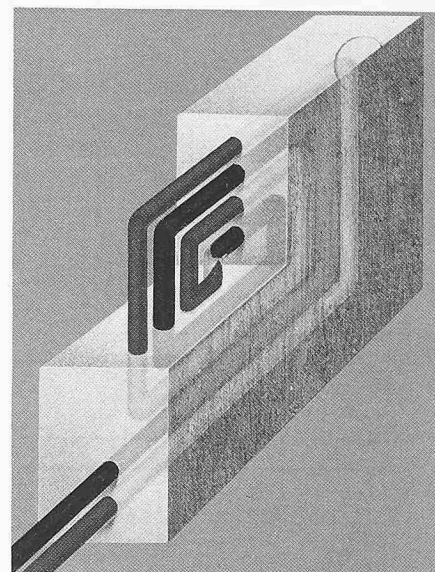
Aufbau eines Massivabsorbers. In vorgefertigte Beton-Aussenbauteile sind flüssigkeitsdurchströmte Rohrleitungen eingegossen
